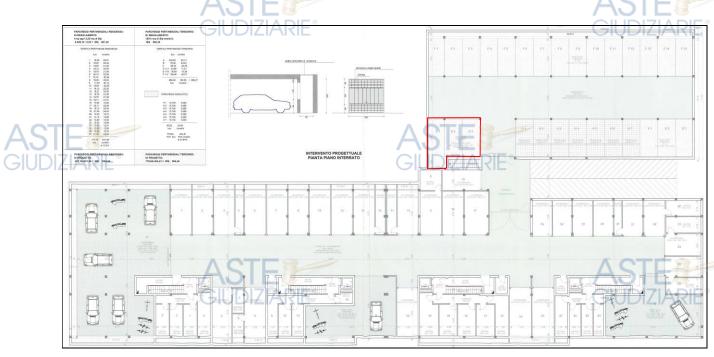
Estratto Tav. 03 pianta piano interrato D.I.A. Prot. 22527 del 24.05.2004 con indicazione delle unità immobiliari in oggetto
